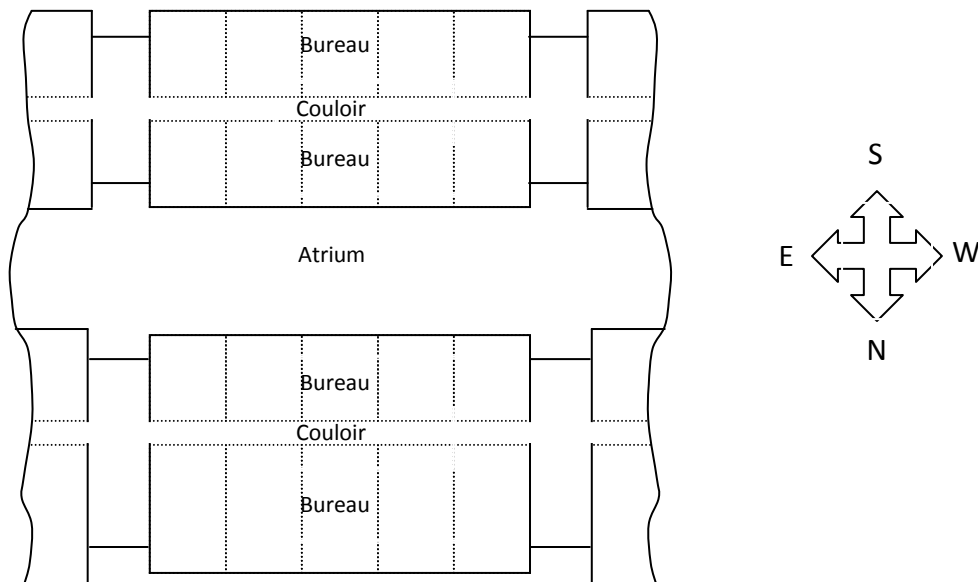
SCHEMA PLAN D'UN MODULE TYPE ⁸
